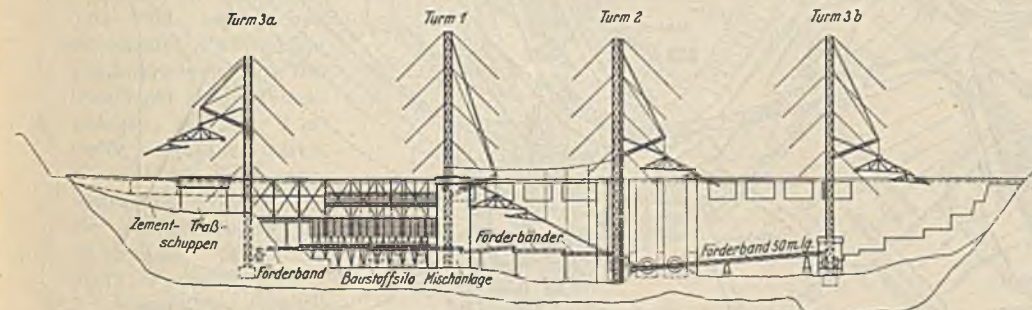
Kriebsteinsperre. Betoneinbringung durch Gießtürme.
